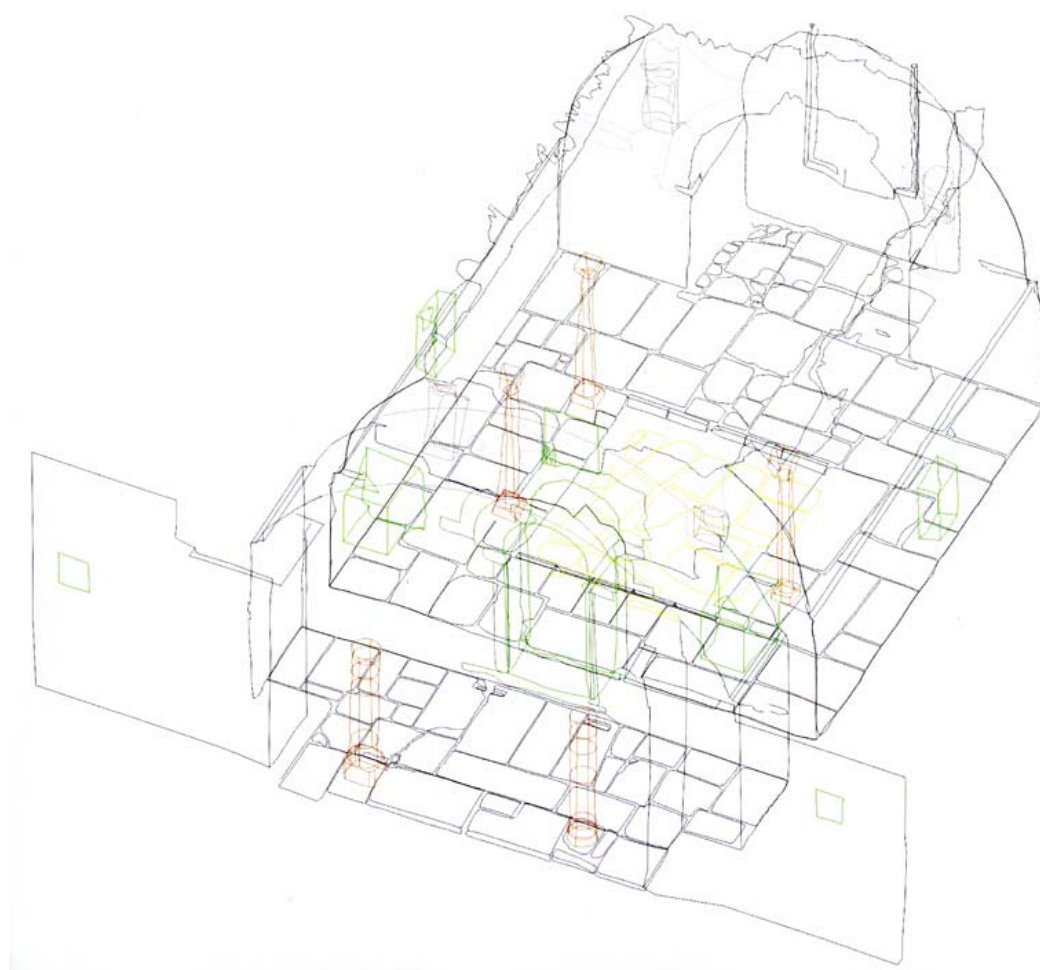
Recreaciones de las tres primeras fases constructivas propuestas
